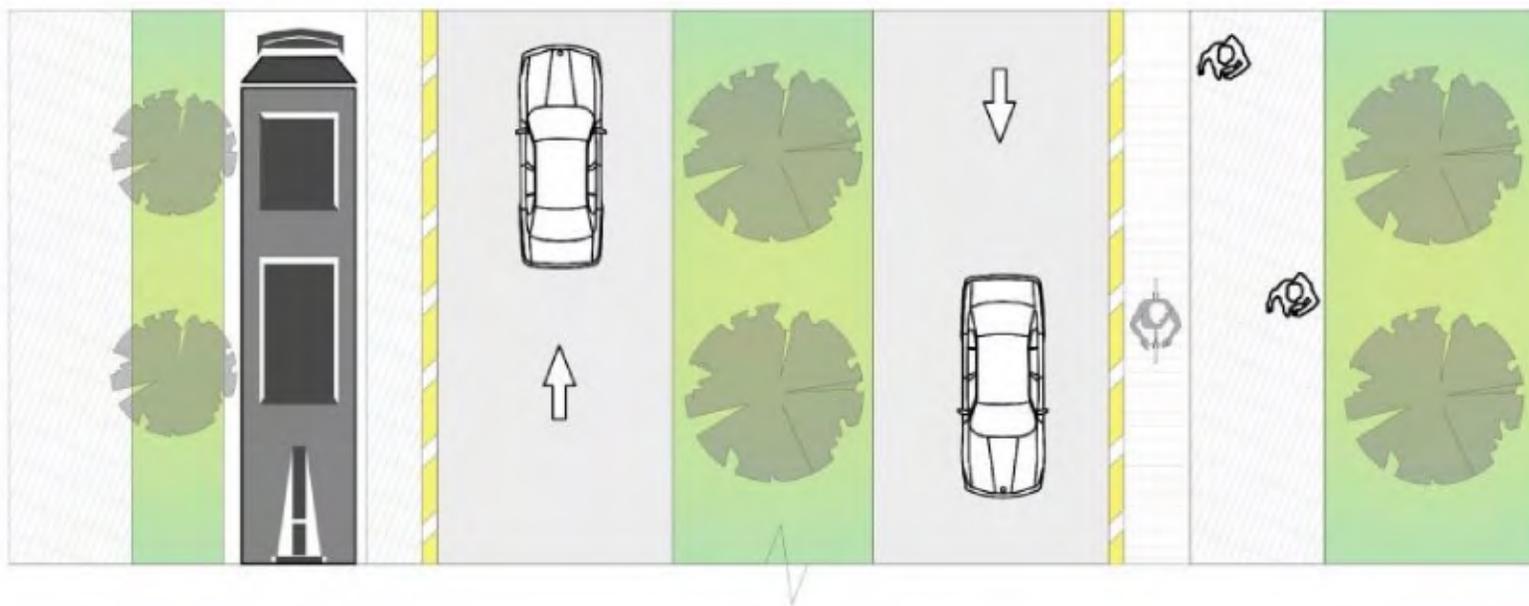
CORTE URBANO 2-2. (fuente: Elaboración Propia)
